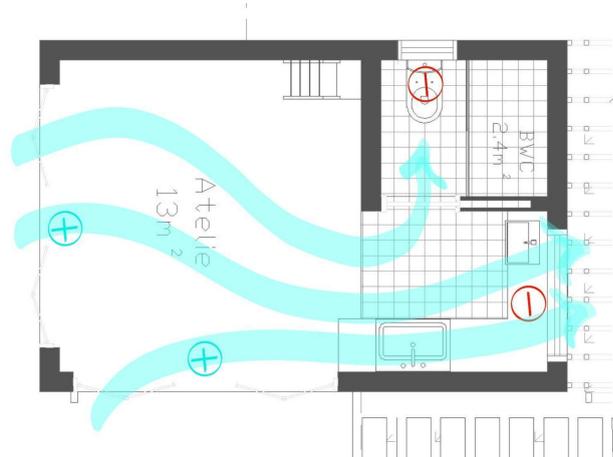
Esquema em planta baixa de simulação de ventilação na edificação
